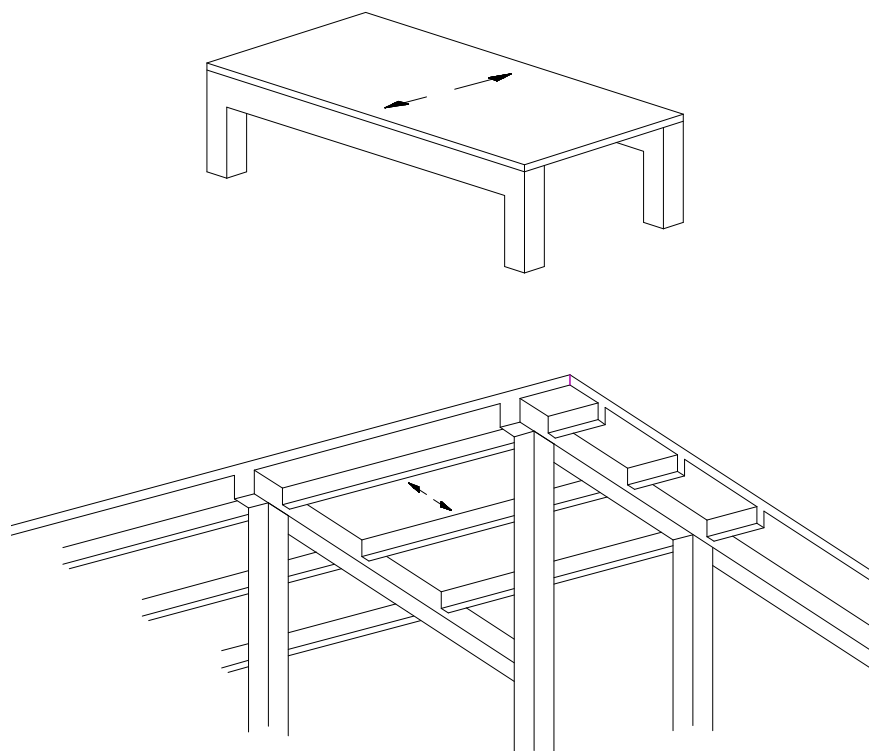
SISTEMAS DE LOSA MACIZA Y VIGAS TRABAJANDO EN UNA DIRECCIÓN
